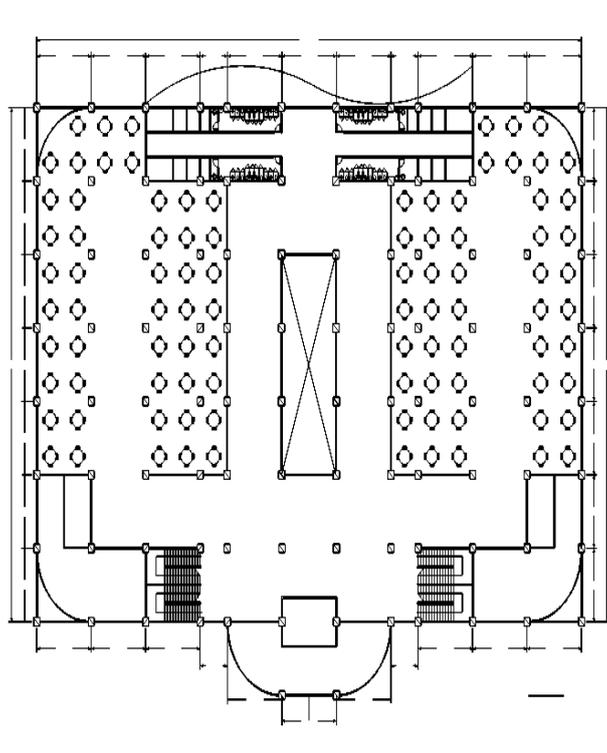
Denah Lantai 2 Hasil *Redesign
